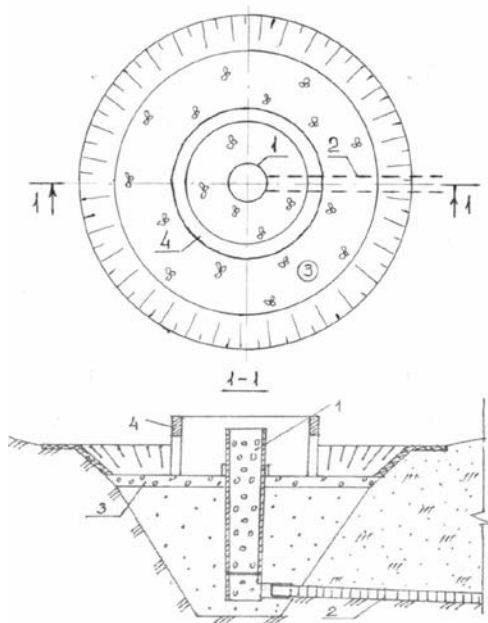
Схема колодца-поглотителя: 1 – полиэтиленовая перфорированная труба; 2 – водоотводящая труба; 3 – гравий слоем 10 см; 4 – стеновое кольцо
